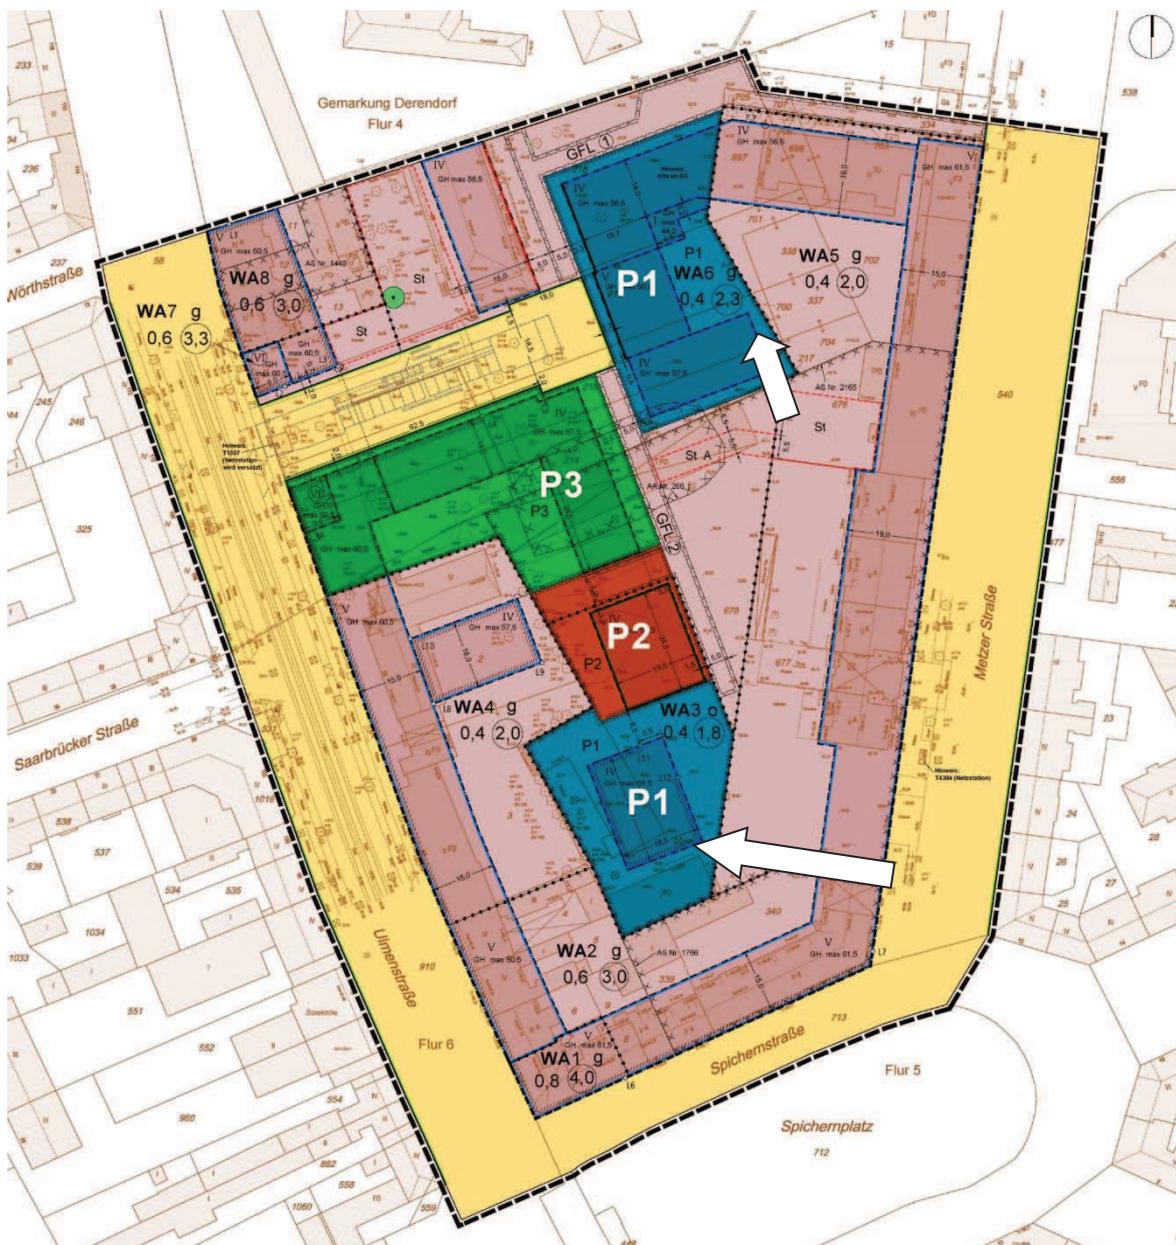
Lageplan – Verteilung Mindestdicken Substratschichten auf Tiefgaragen (Quelle: ISR)
